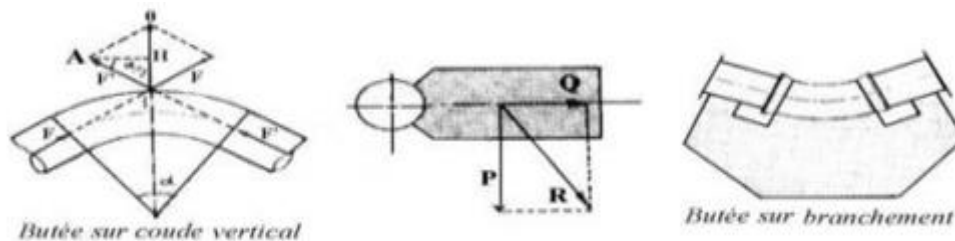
Butée sur coude vertical et Butée sur branchement [10]
